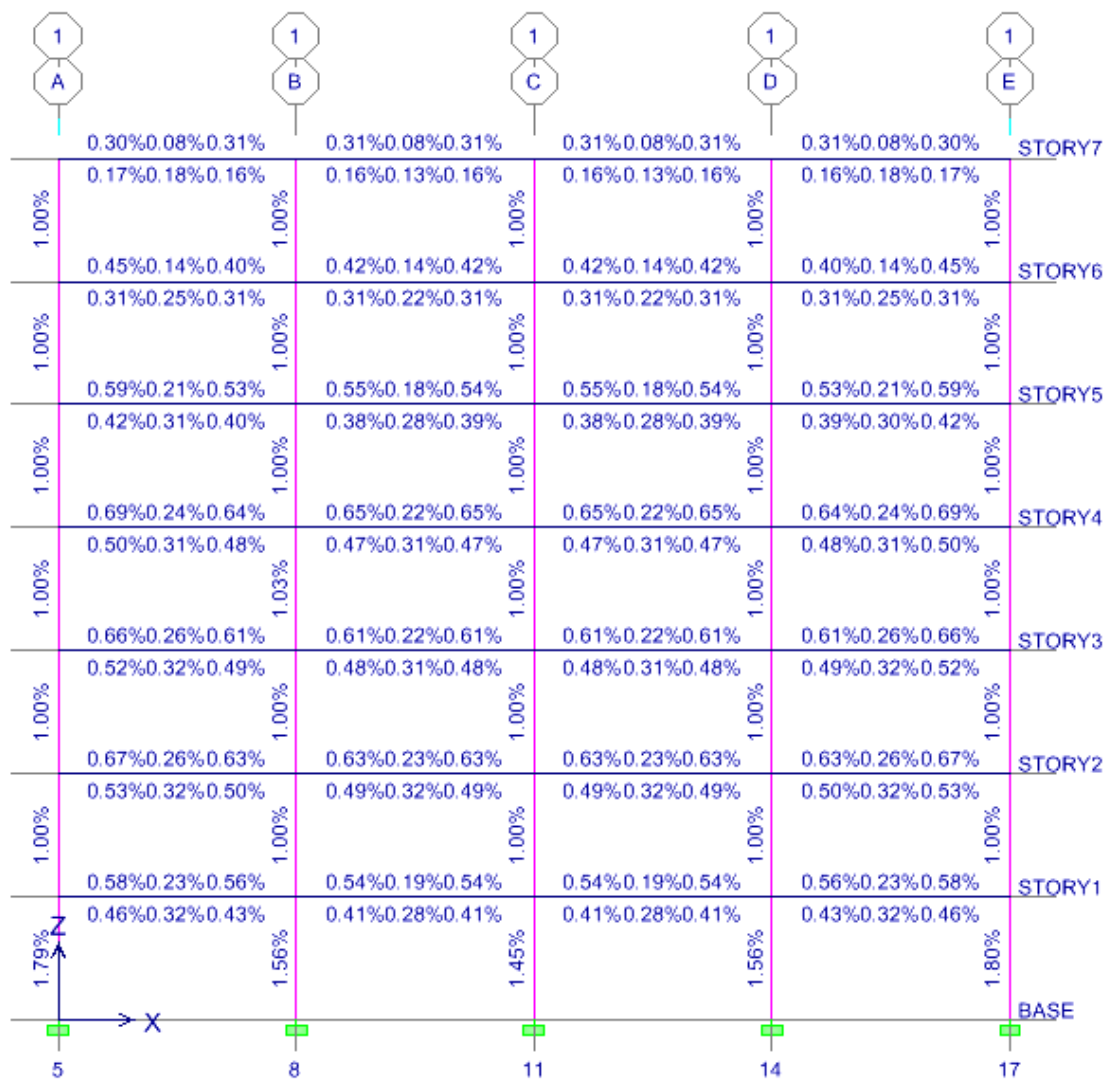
Detalle de la cuantía de refuerzo del edificio en elevación (pórtico 1)
